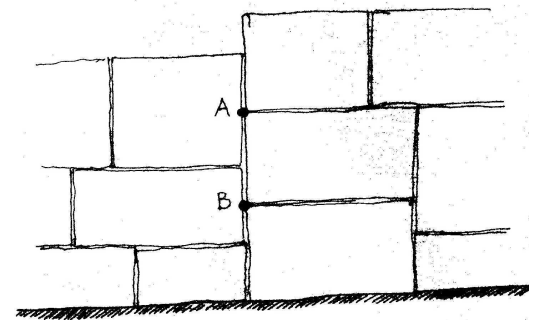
Faiblesse de cohésion si le croisement des joints verticaux n'est pas assuré.
